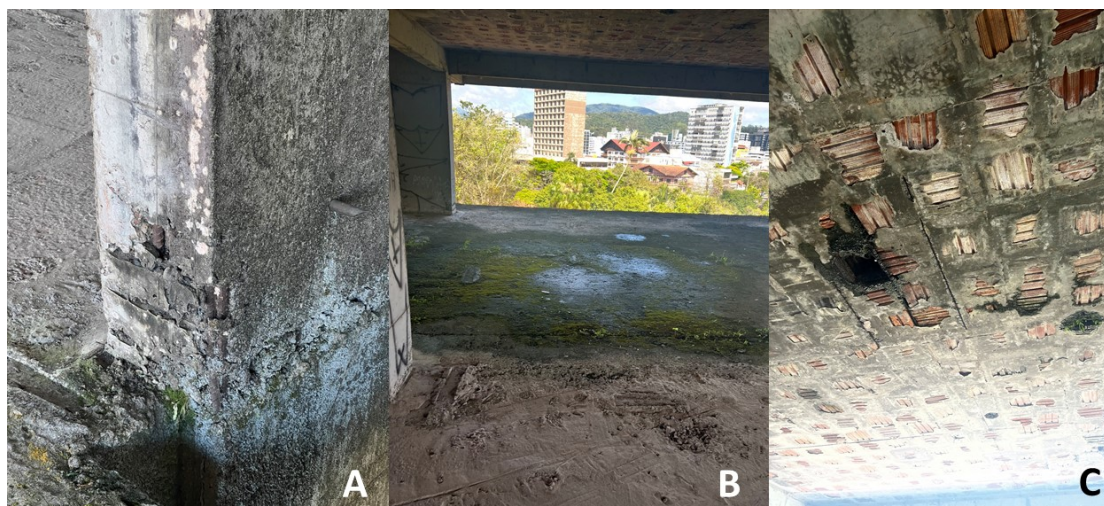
Patologias no quinto andar, laje P29, P30, P38, P39: (A) betão com buracos (P31); (B) laje inferior: musgos; (C) laje superior: infiltrações e blocos cerâmicos quebrados.
